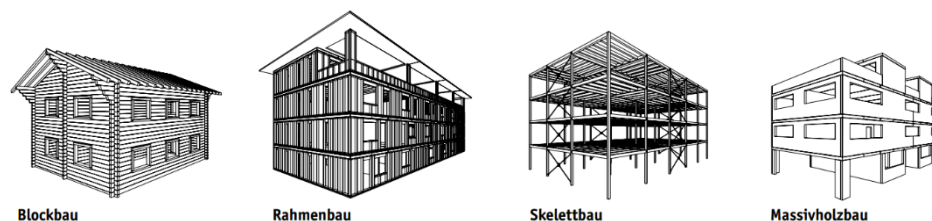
Principais tipos estruturais (paredes de toros, painéis reticulados, porticado e painéis maciços) (Lignum ®) ([http://www.lignum.ch/uploads/media/Holzbau\\_Argumente.pdf](http://www.lignum.ch/uploads/media/Holzbau_Argumente.pdf)).
